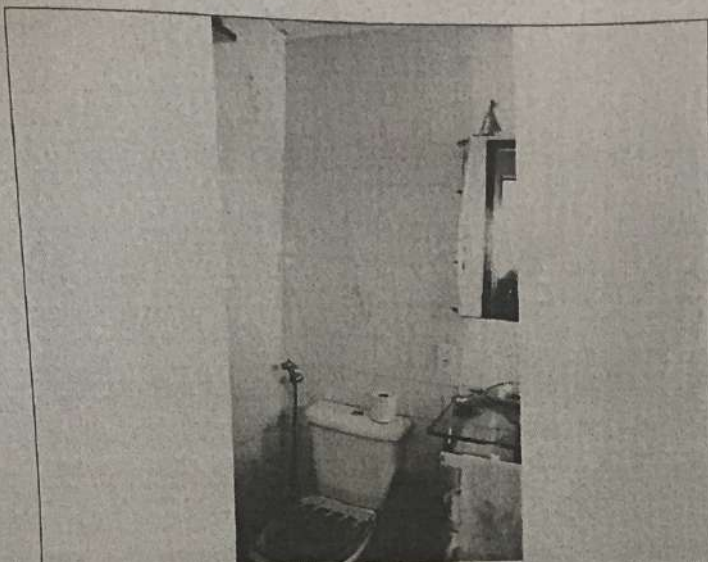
Detalhe do Banheiro do Apartamento Nº 72. Nota-se seu estado de conservação e os diversos materiais de acabamento e construção.
